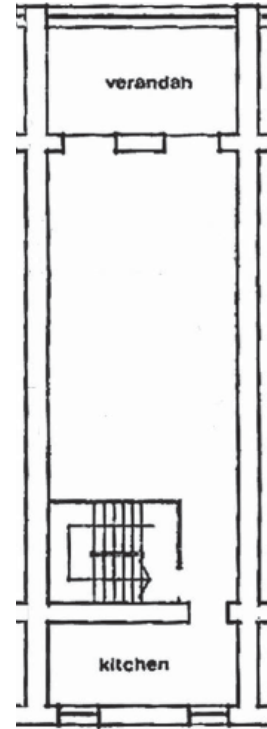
Tong Lau mit Veranda, 290 Queen's Road
